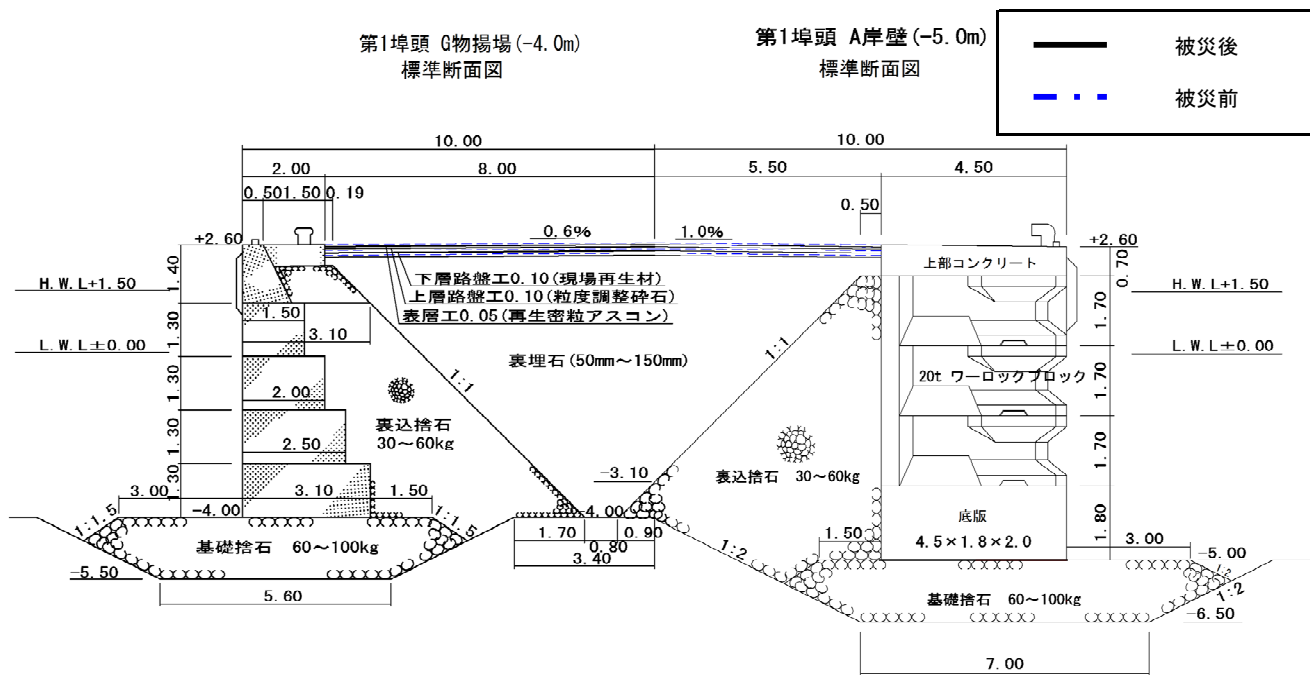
No.27 大洗港区\_第1埠頭 G 物揚場 (-4.0m) (水産ふ頭地区) の断面図 (被災後)
